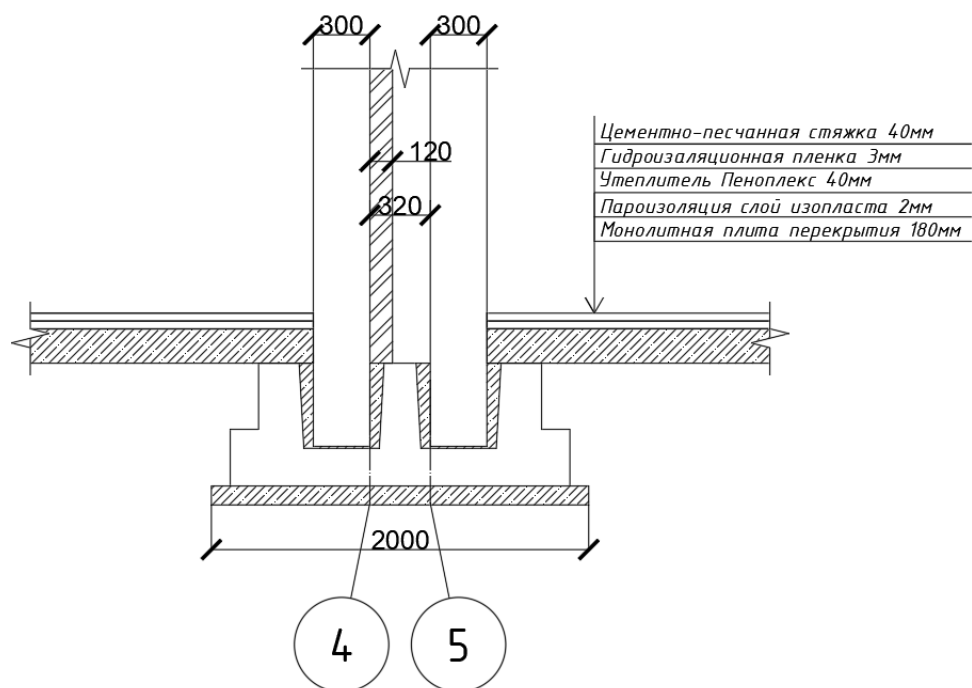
Сечение столбчатого фундамента Ф-2.
